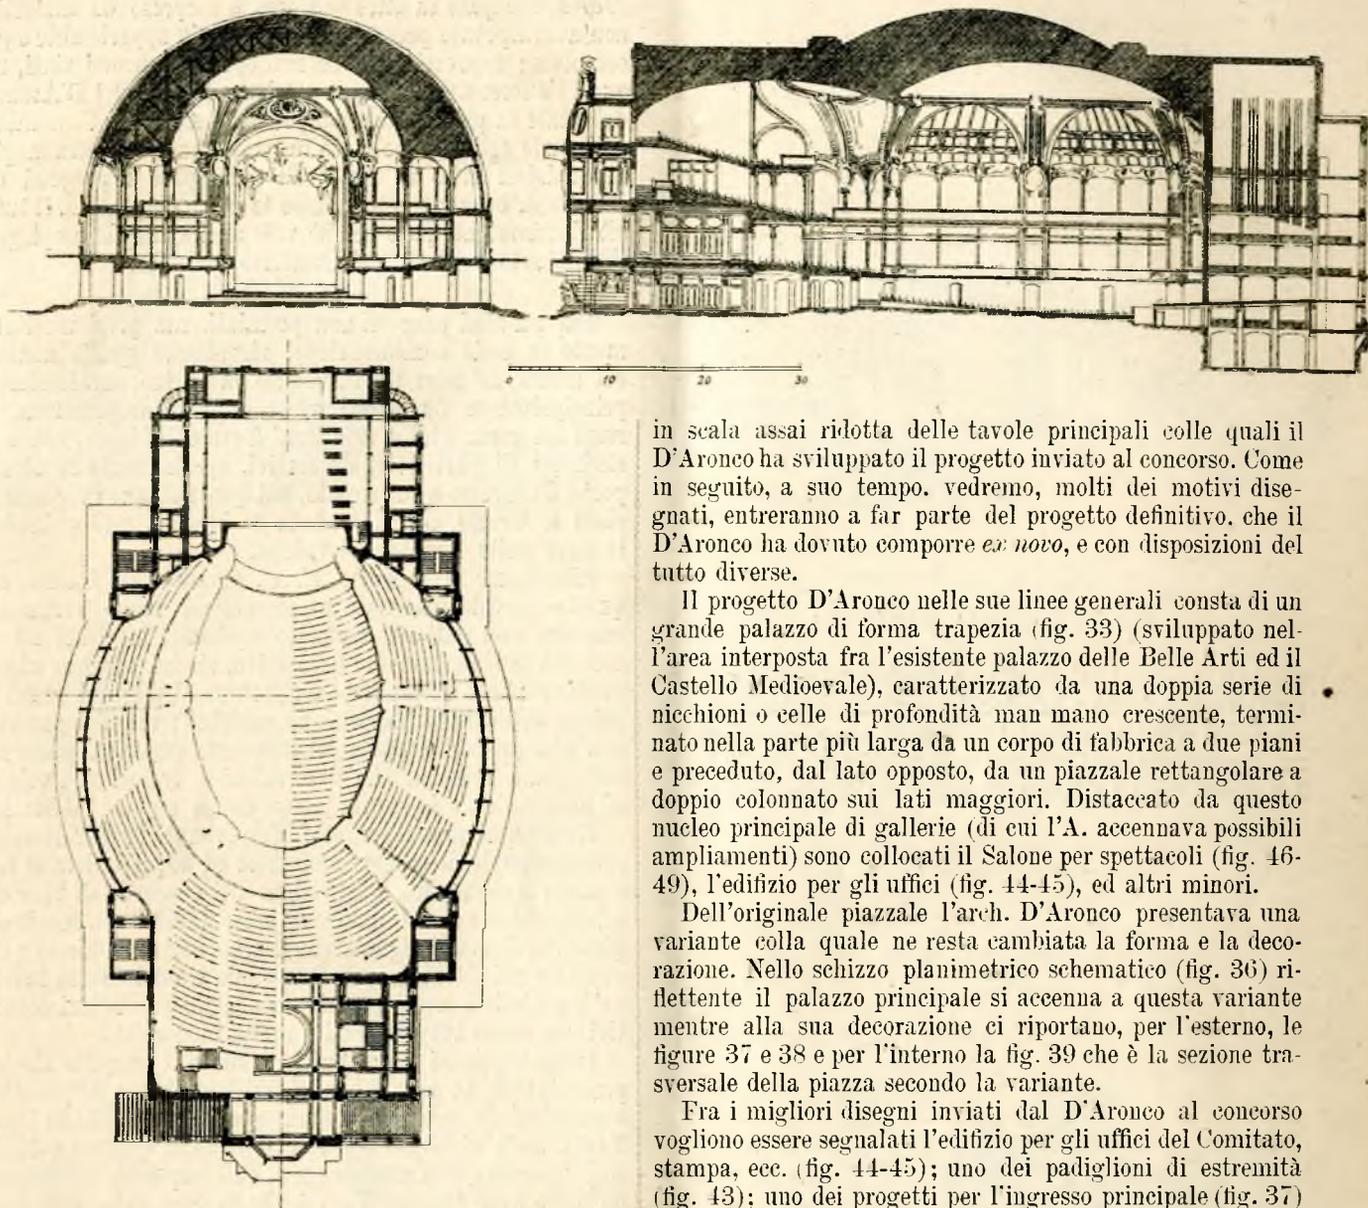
, 48 e 49. — Pianta e sezioni della sala per concerti, spettacoli, ecc.
